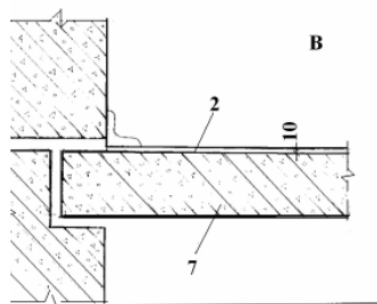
Конструкція підлоги на залізобетонній плиті
